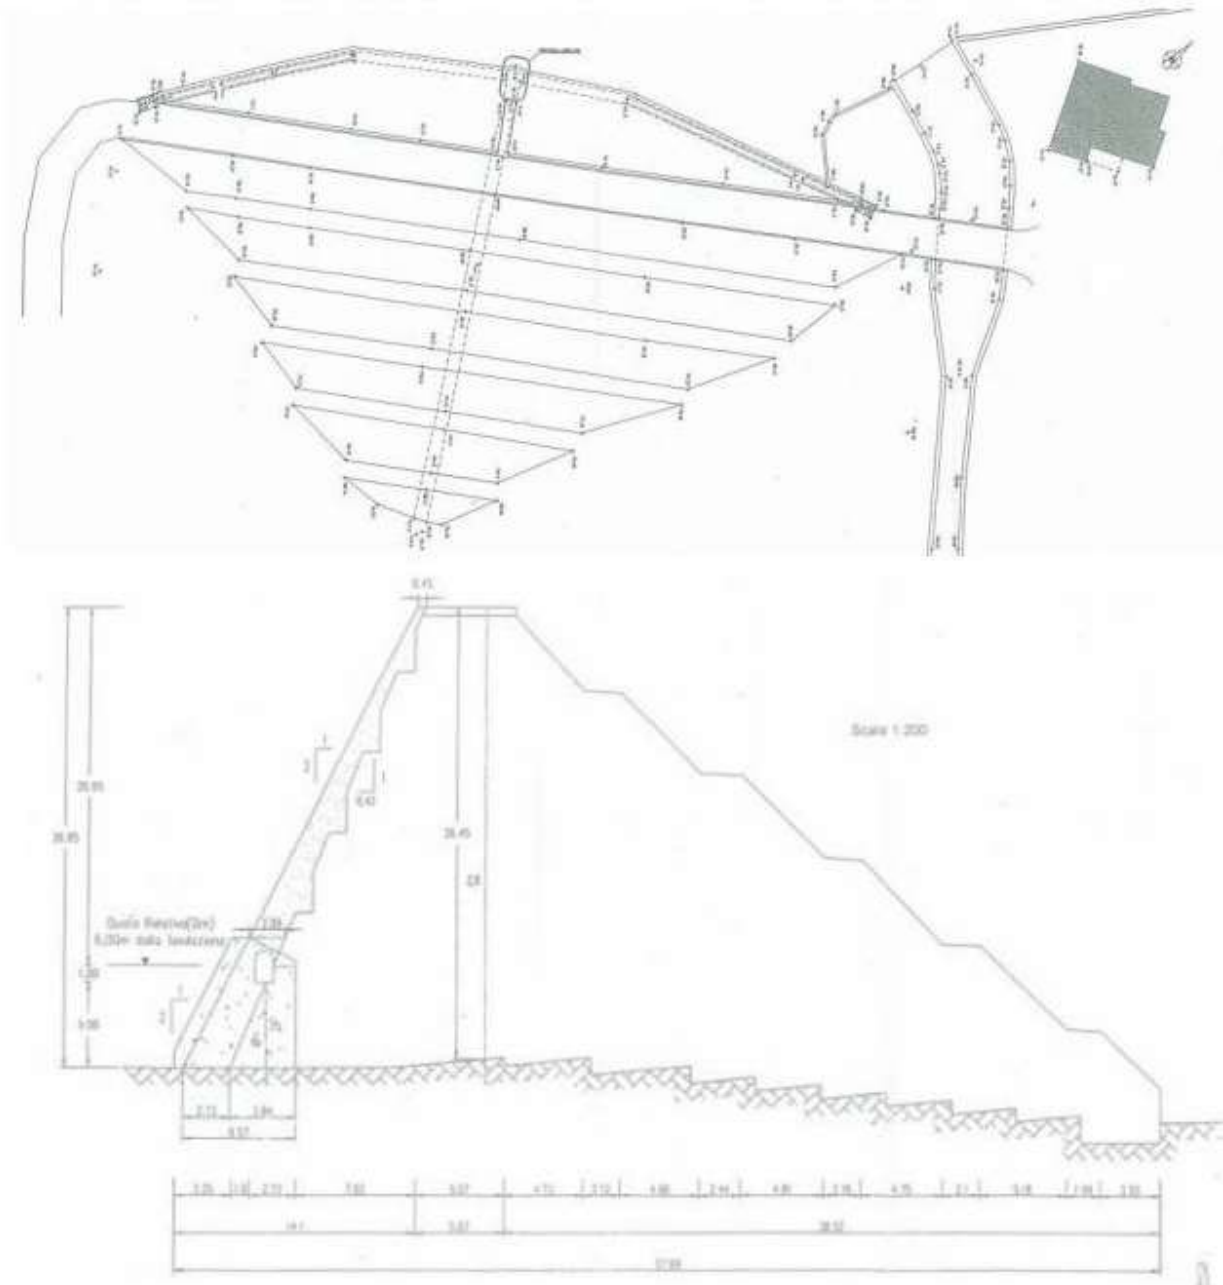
Pianta e sezione maestra della Diga di Cerventosa, tratte dal FCEM 2004
